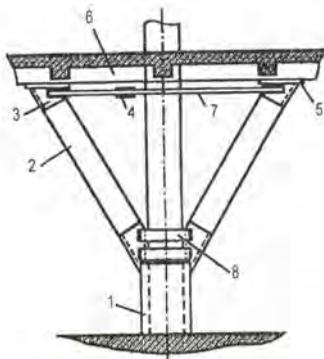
Усиление с частичным разгрузением конструкции (дополнительная жесткая опора – сборные железобетонные подкосы): 1 – обойма; 2 – подкосы; 3 – оголовник; 4 – натяжная муфта; 5 – подкладка; 6 – усиливаемый ригель; 7 – затяжка; 8 – планки
